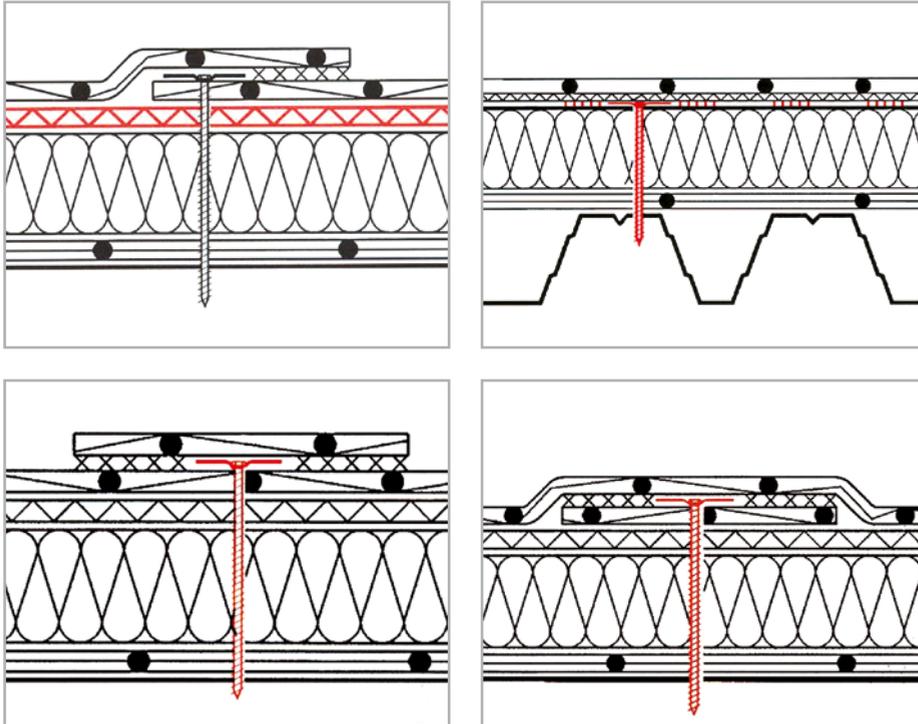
bis 709: Arten der Dachverankerung: (li) Saumbefestigung; (re) Verankerung reißfester Klappdämmung oder Altdach; (li u) Dachhautverankerung mit Abdeckflecken; (re u) Schweißstellen mit verdeckter Schweißung oder Klettbandbefestigung (Quelle: FDT Flachdachtechnik)
